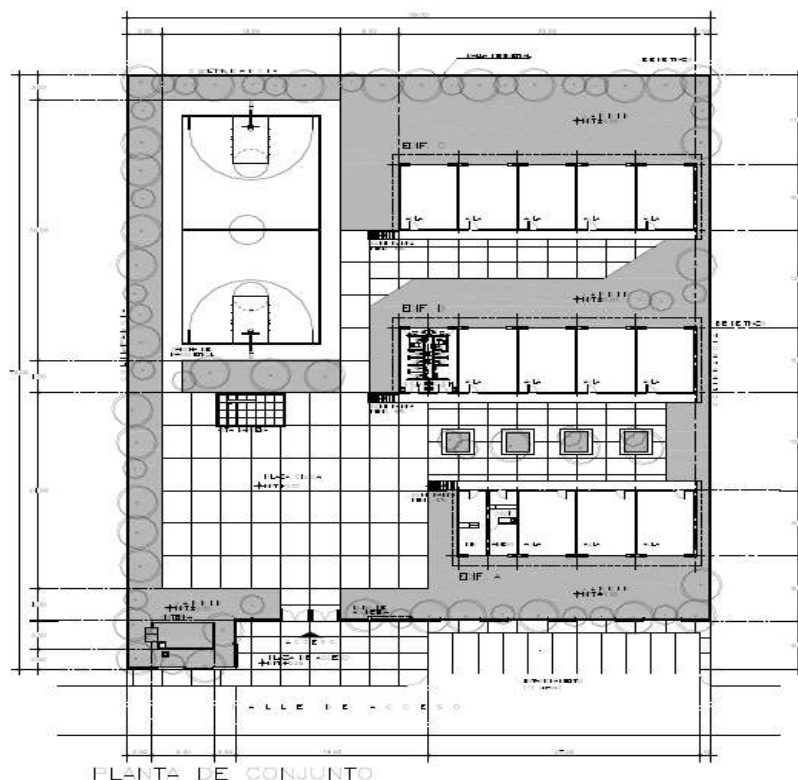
planta arquitectónica de edificio de la ENSM Morelia
